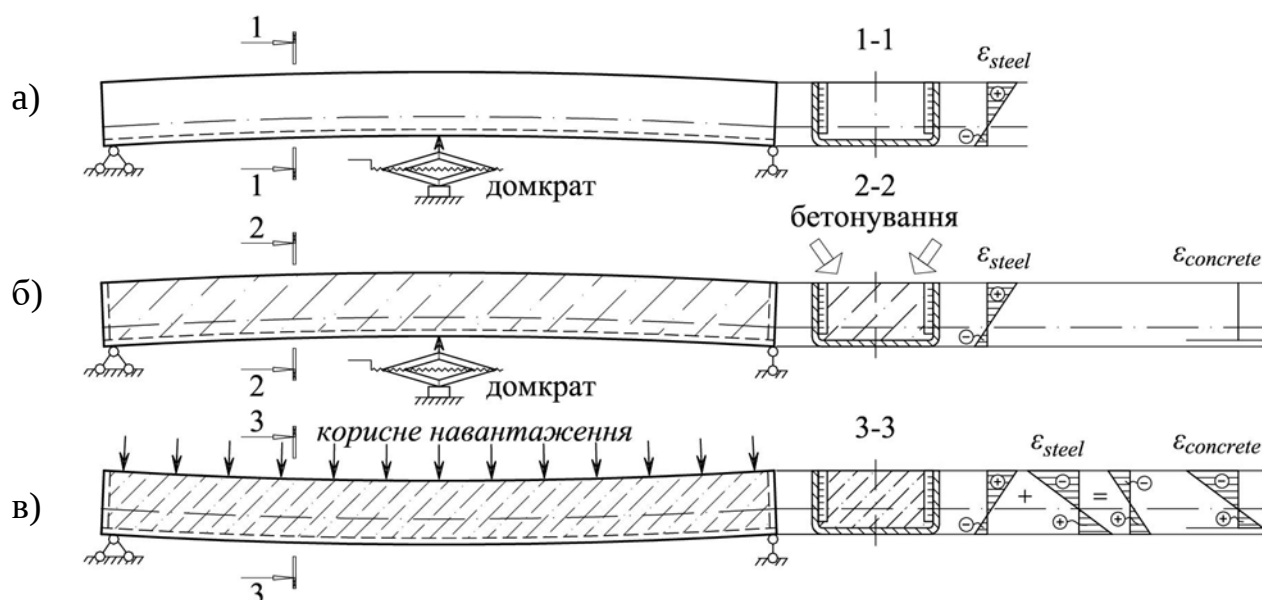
Стадії роботи попередньо напруженого сталезалізобетонного стержня:
